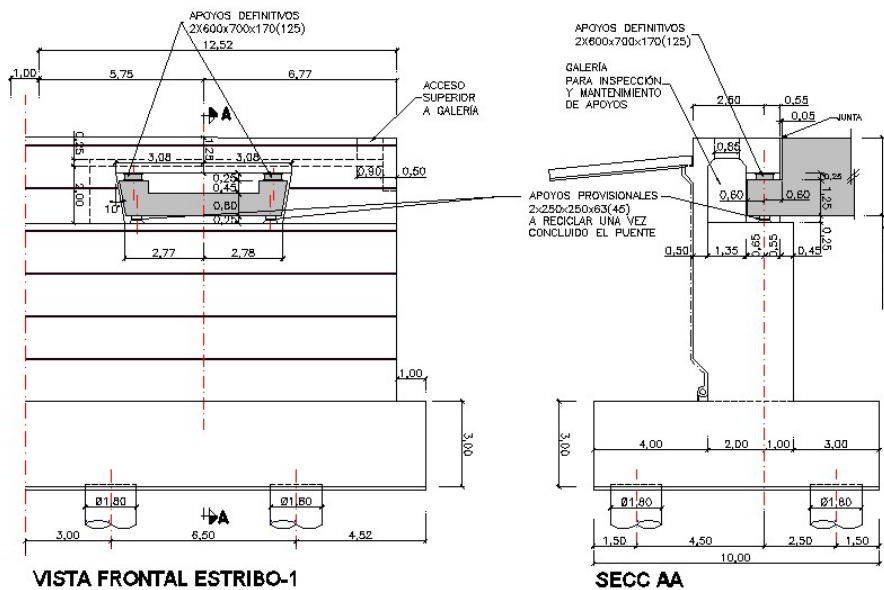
Vista del alzado y sección de los estribos con los detalles de los apoyos inversos.
